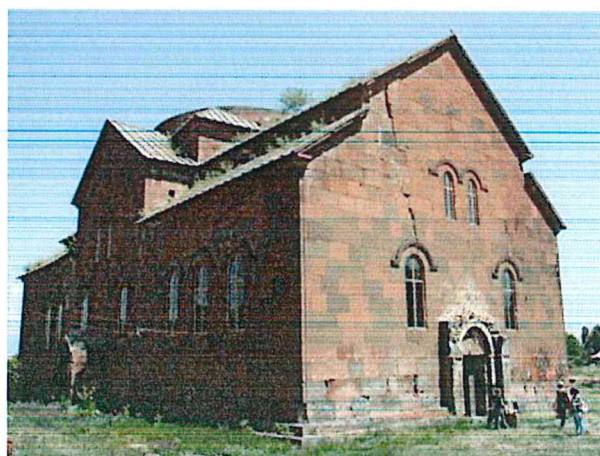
Arudj, Yerevan, Armenia, cantiere-scuola.
